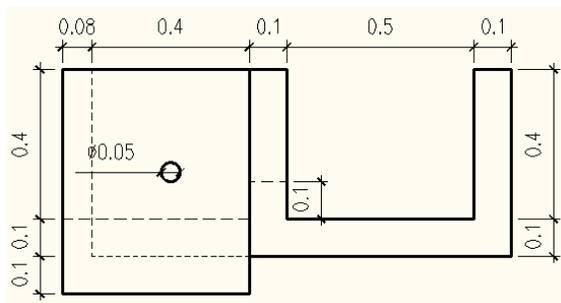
Vista de corte transversal del vertedero y sedimentador (D. Salazar)
